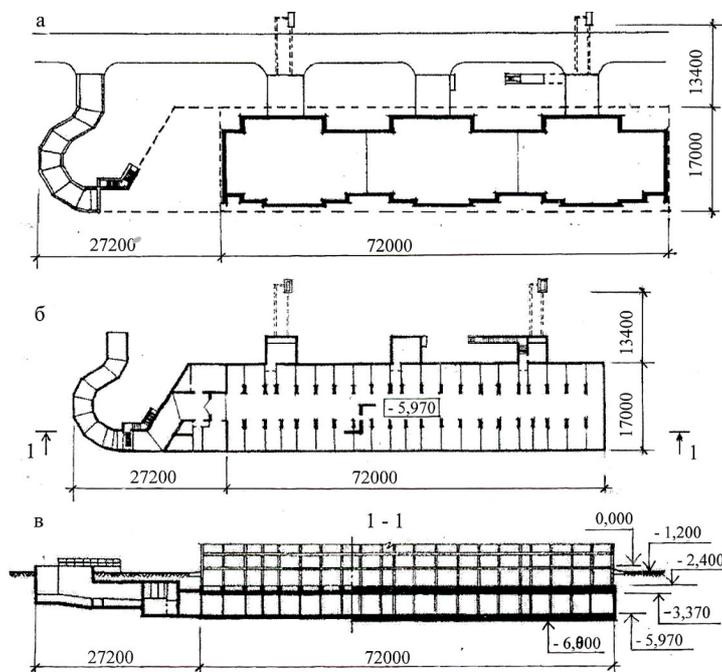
Монолитный гараж-стоянка на 39 автомашин под трехсекционным жилым домом с узким шагом несущих стен: а – схема генерального плана; б – план гаража; в - разрез
